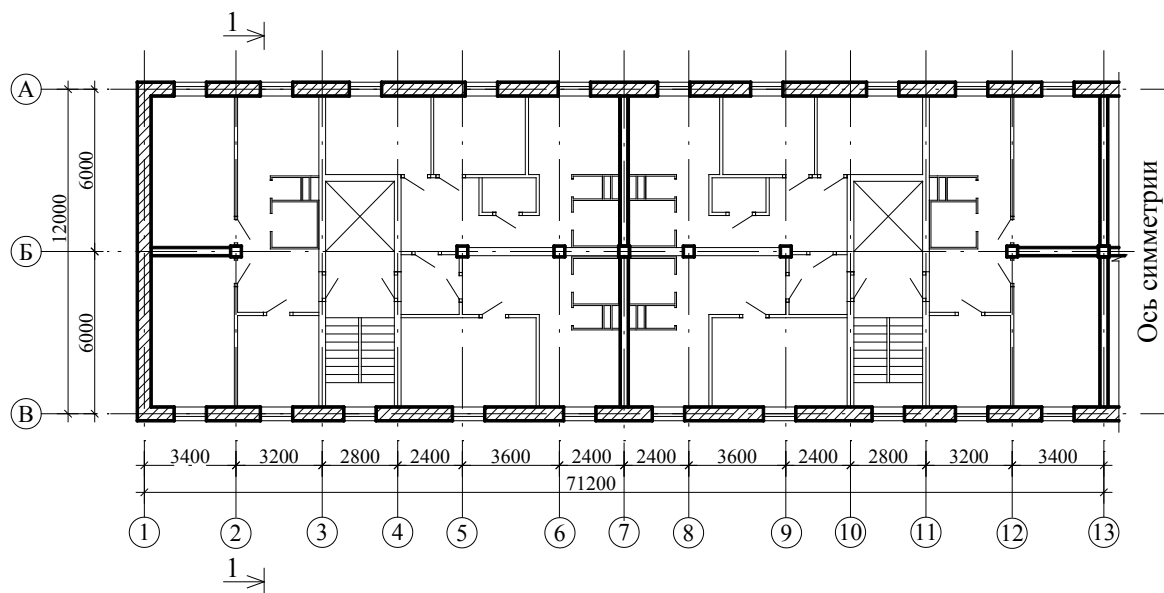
Первая — конструктивная — часть задания на проектирование
